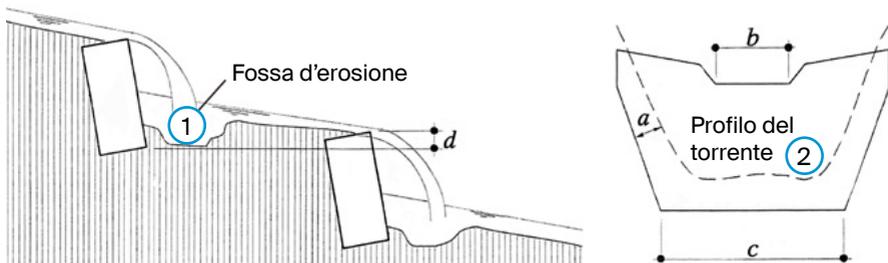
Dimensionamento della briglia: sezione e prospetto (USTRÀ)
